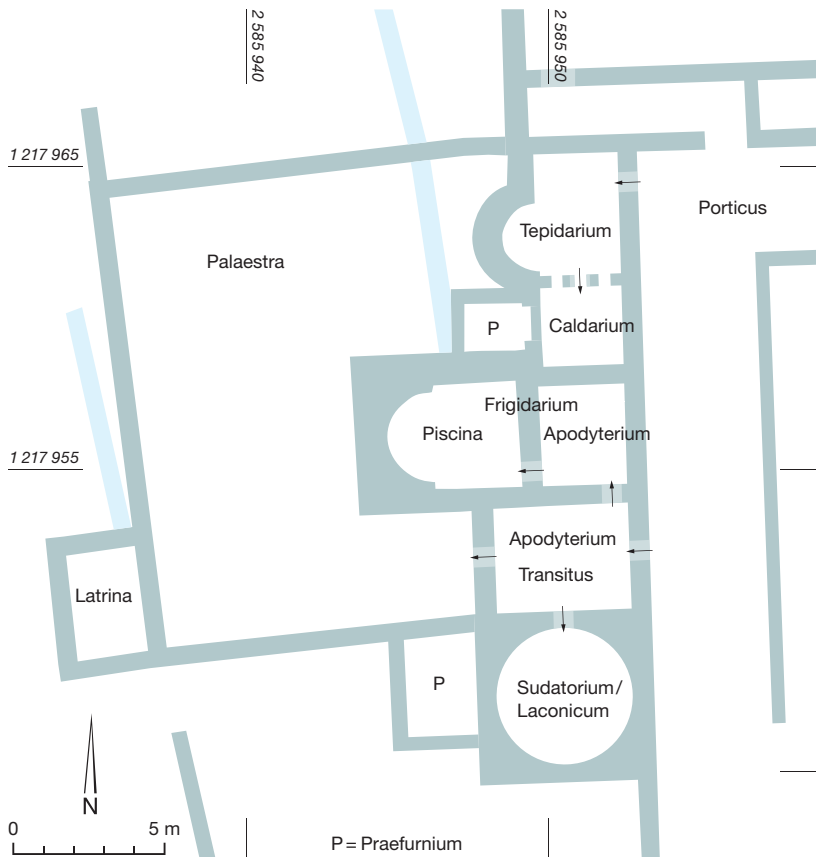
Port, Bellevue. Grundriss der Badeanlage. M. 1:250.
